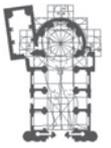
Situación en planta de las inyecciones de lechada de cemento para rigidización de la cimentación. En sombreado, las posibles inyecciones con profundidad suplementaria hasta alcanzar las gravas
